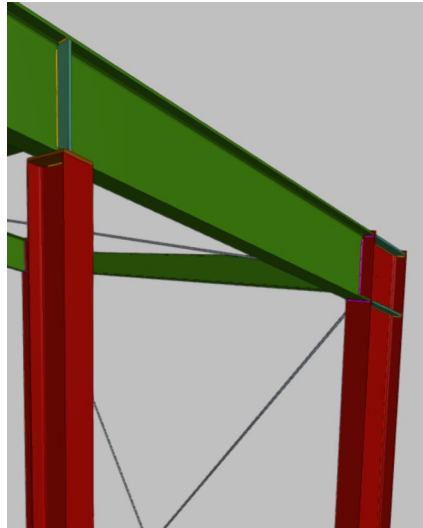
Detalle de los pilares de apoyo girados 90 grados
